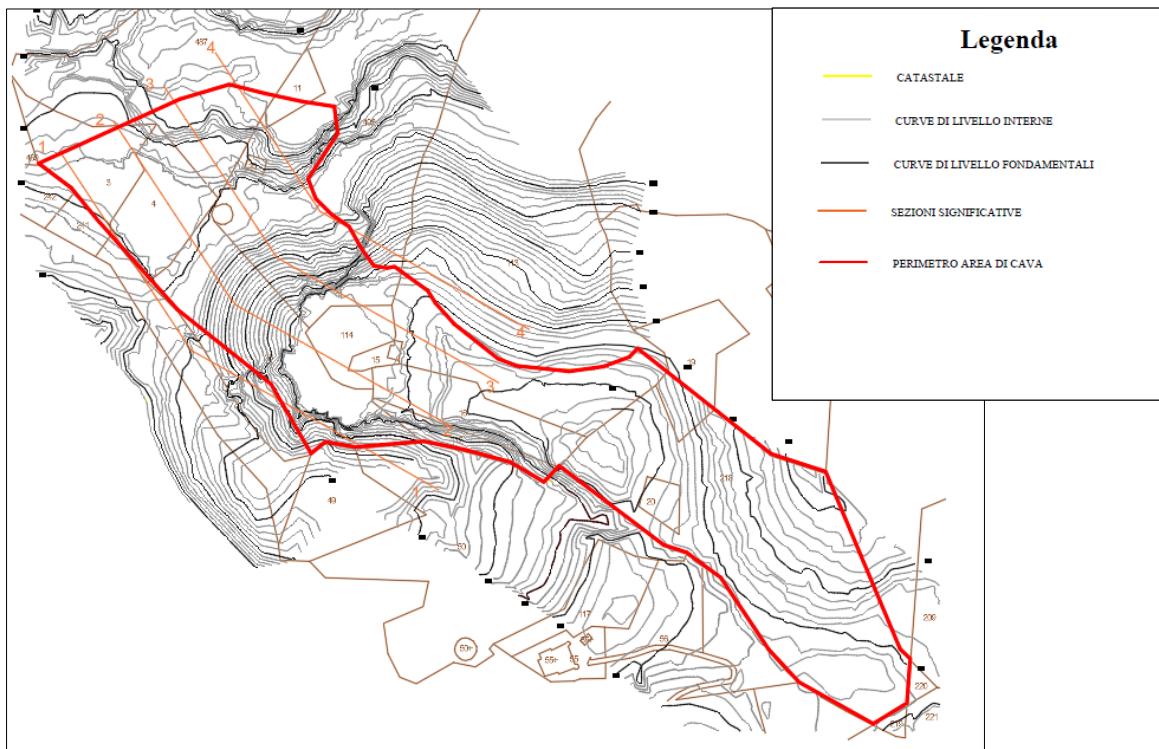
PLANIMETRIA _ STATO DI FATTO
